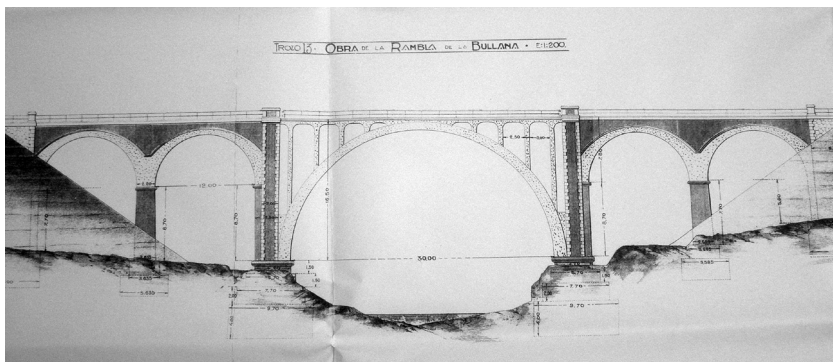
Proyecto modificado puente sobre rambla Bullana (AGA. 26/22108)
